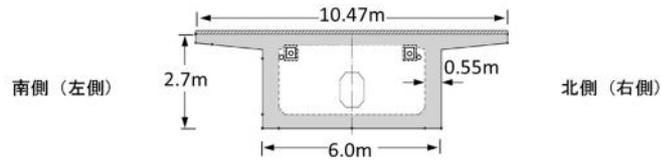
ひび割れ点検箇所図 (続き)
